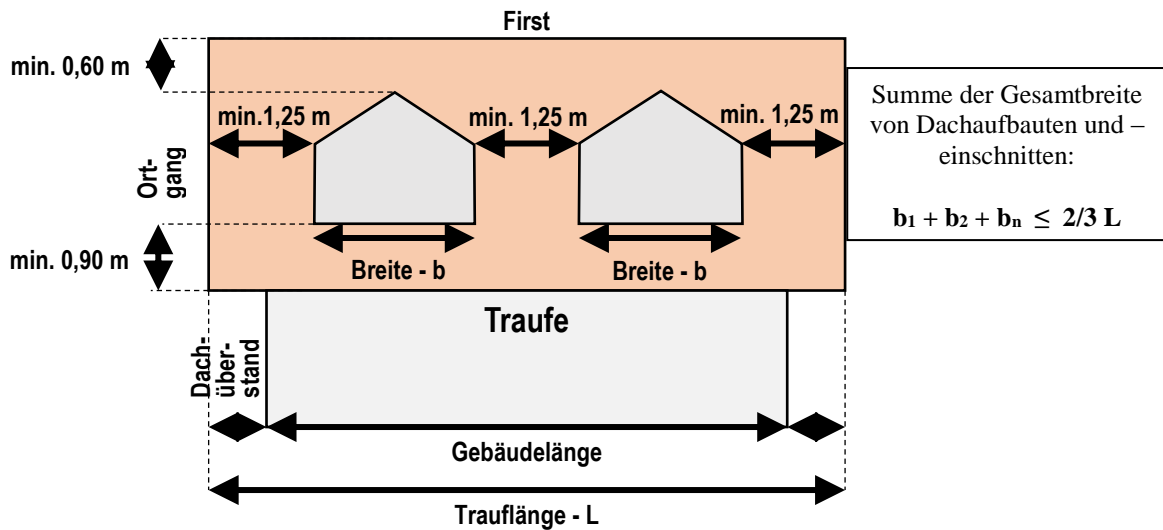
Abmessungen zulässiger Dachgauben (hier Beispiel: Sattelgaube)
